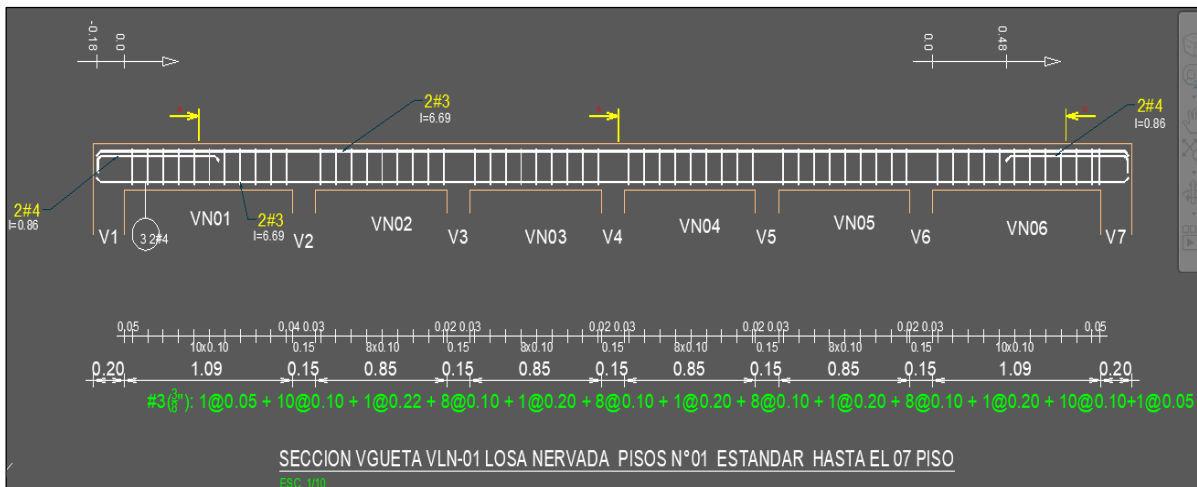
Plano de la vigueta continua en el eje XX la losa nervada 01.
